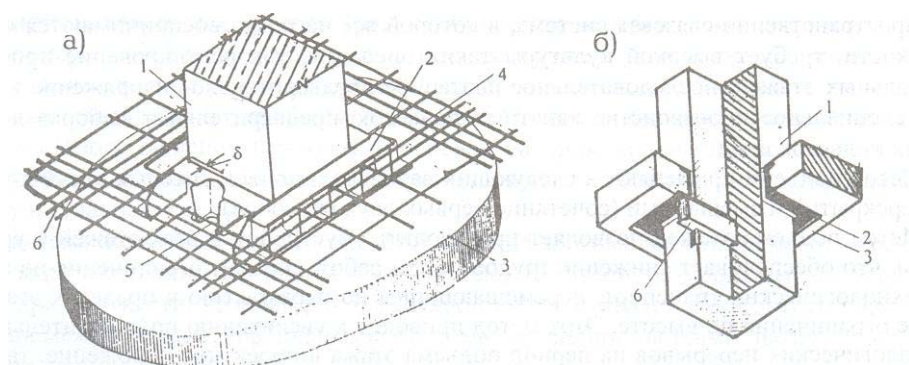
Конструкция соединения плиты перекрытия с колонной: а) конструктивная схема установки воротника в плите перекрытия; б) узел крепления плиты перекрытия с колонной; 1 – колонна; 2- воротник; 3 – плита перекрытия; 4 – арматура; 5 – гнезда для захвата тяги домкрата; 6 – закладной штырь.
